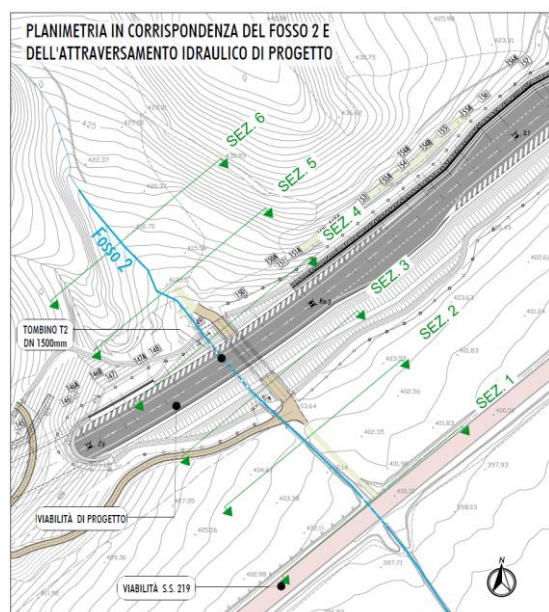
PLANIMETRIA DEL FOSSO 2
